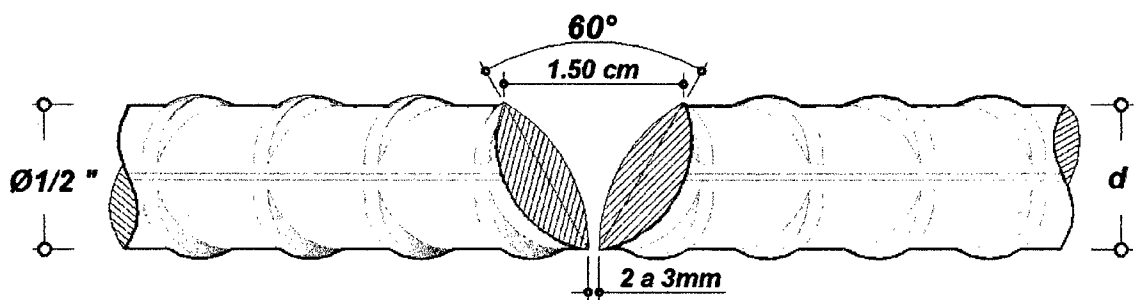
Detalle de corte en miembros de probeta para soldadura a tope directo con borde en "V" en barra de $\varnothing 1/2''$
